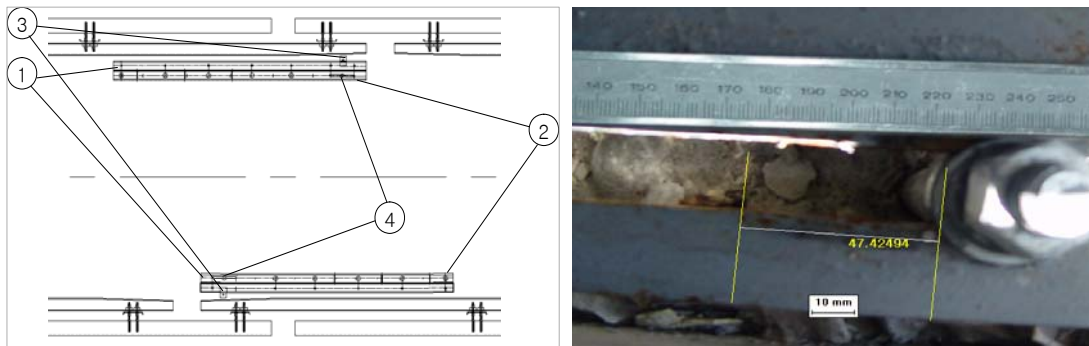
신축이음장치 평면도 및 신축량 측정(47.4mm)
